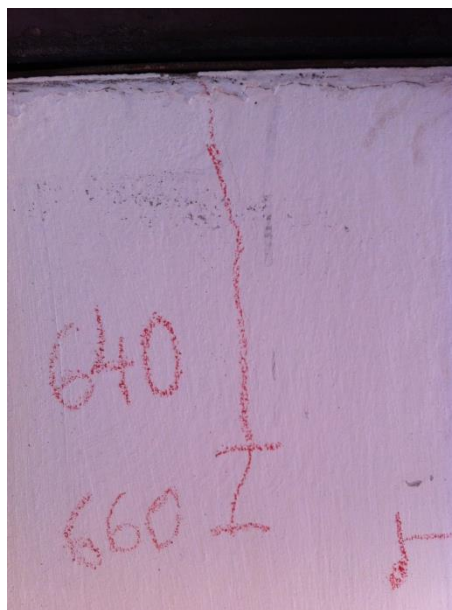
Ocorrência de fissura na carga de primeiro dano do corpo de prova 03 na interface concreto-bloco cerâmico do painel (comprimento de fissura = 20 cm)
